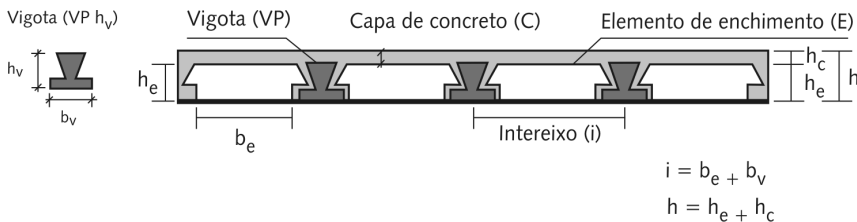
Lajes com vigotas de concreto protendido (LPh)
